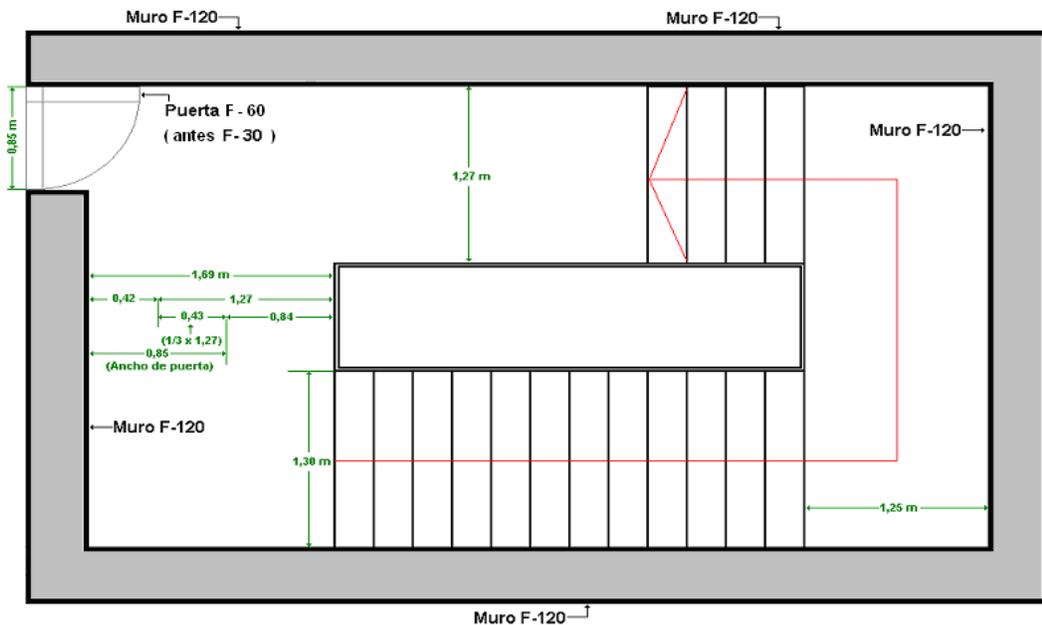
PLANTA TIPO CAJA ESCALERA INTERIOR, PROTECCIÓN RESISTENTE AL FUEGO
